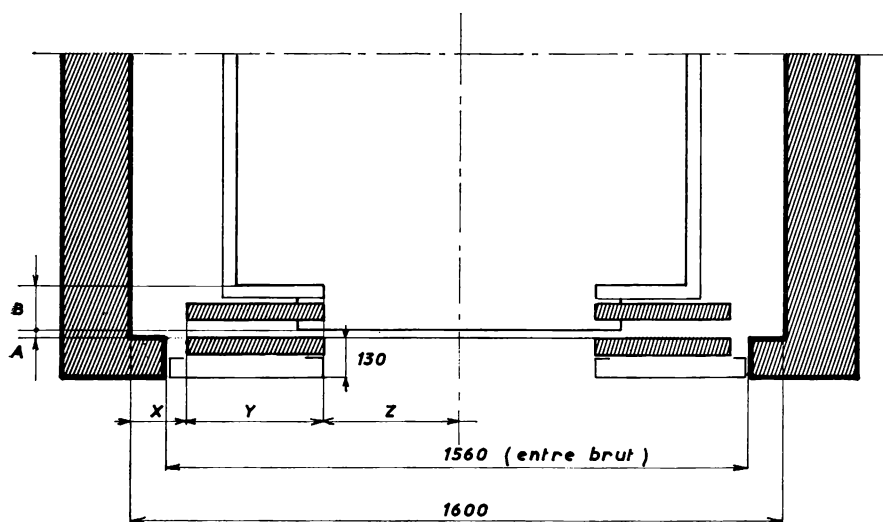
Travaux de maçonnerie pour implantation de porte coulissante à deux vantaux à ouverture centrale avec façade tôlée sur toute la hauteur de la baie (même porte sur cabine)
